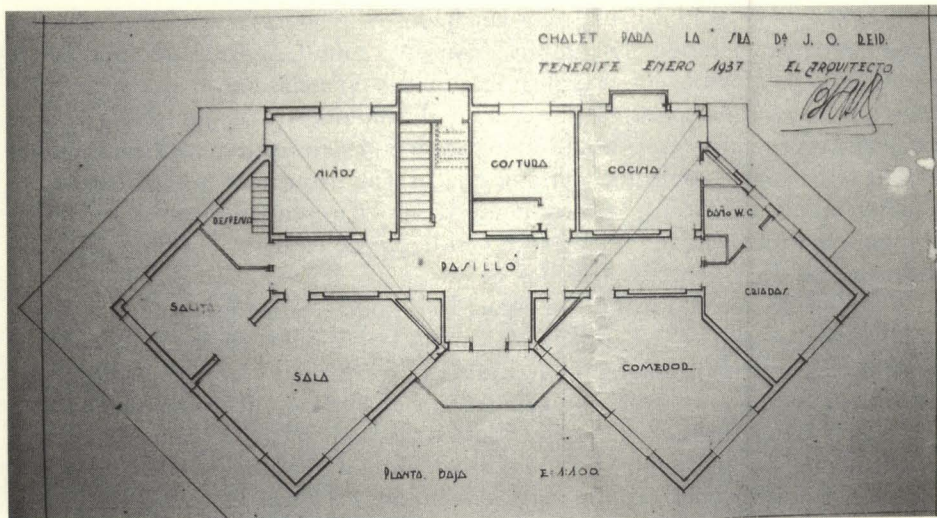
Chalet para la Sra. D^a. J.O. Reid. Planta baja, 1937.
